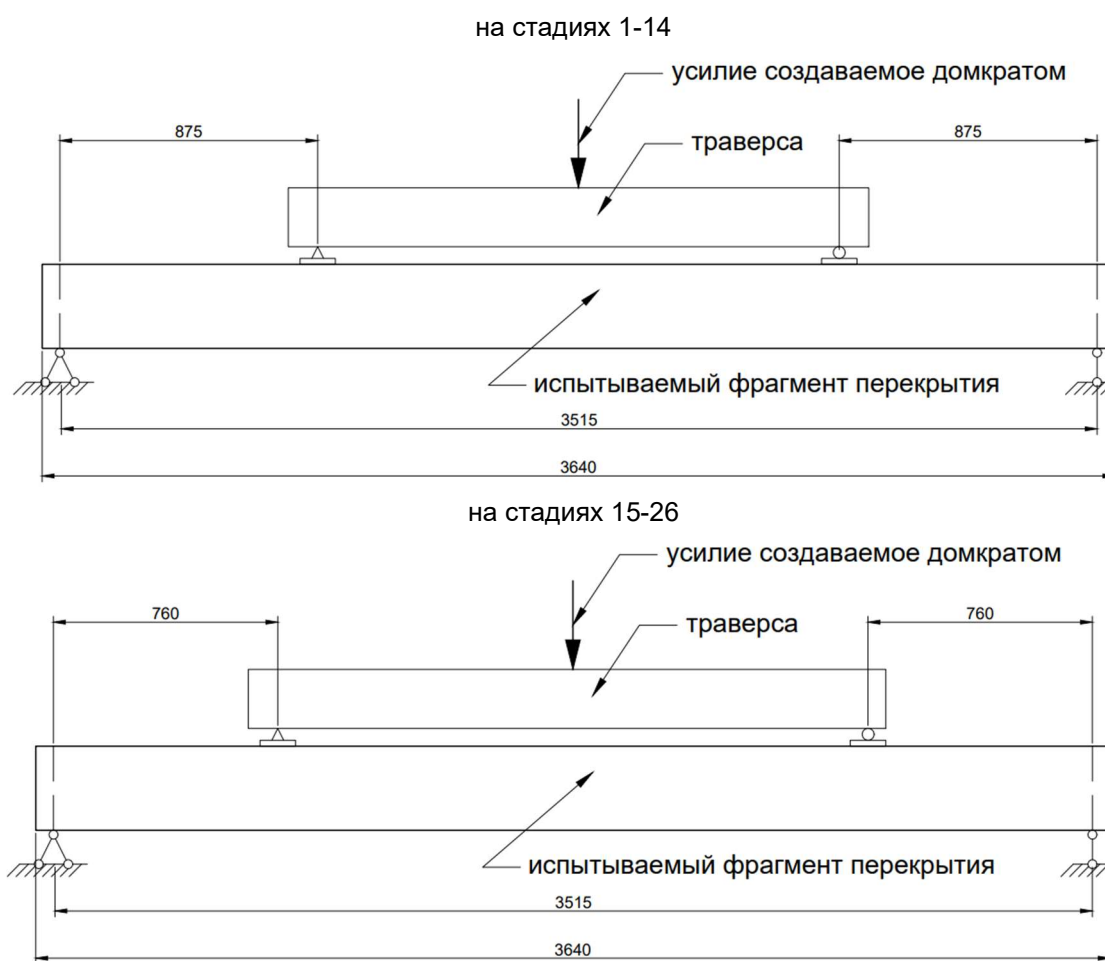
Фрагмент каркаса сборных элементов перекрытия «ДАХ»
